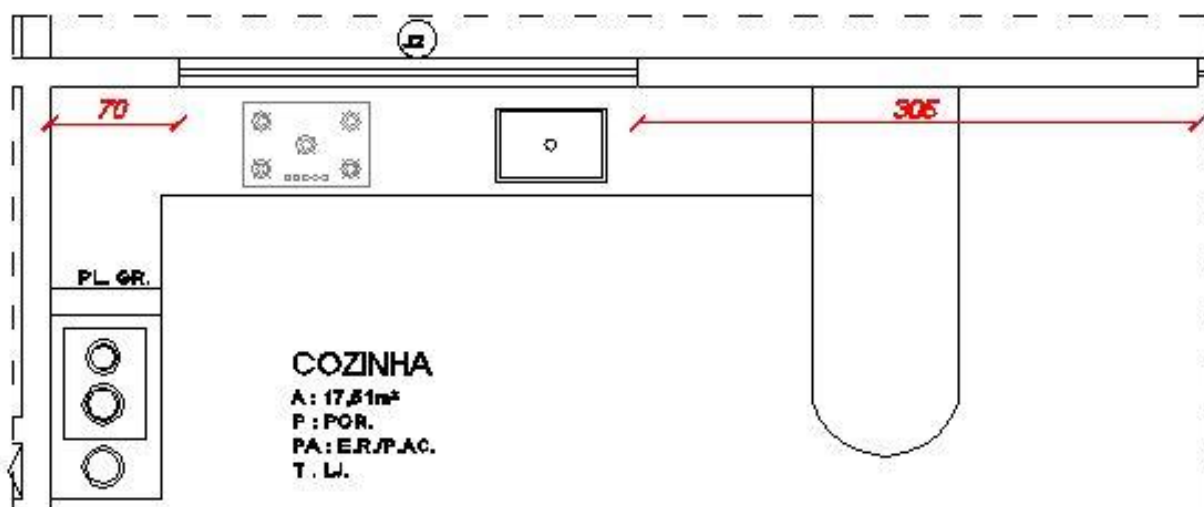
Cota de projeto da esquadria J2 da cozinha, em planta
